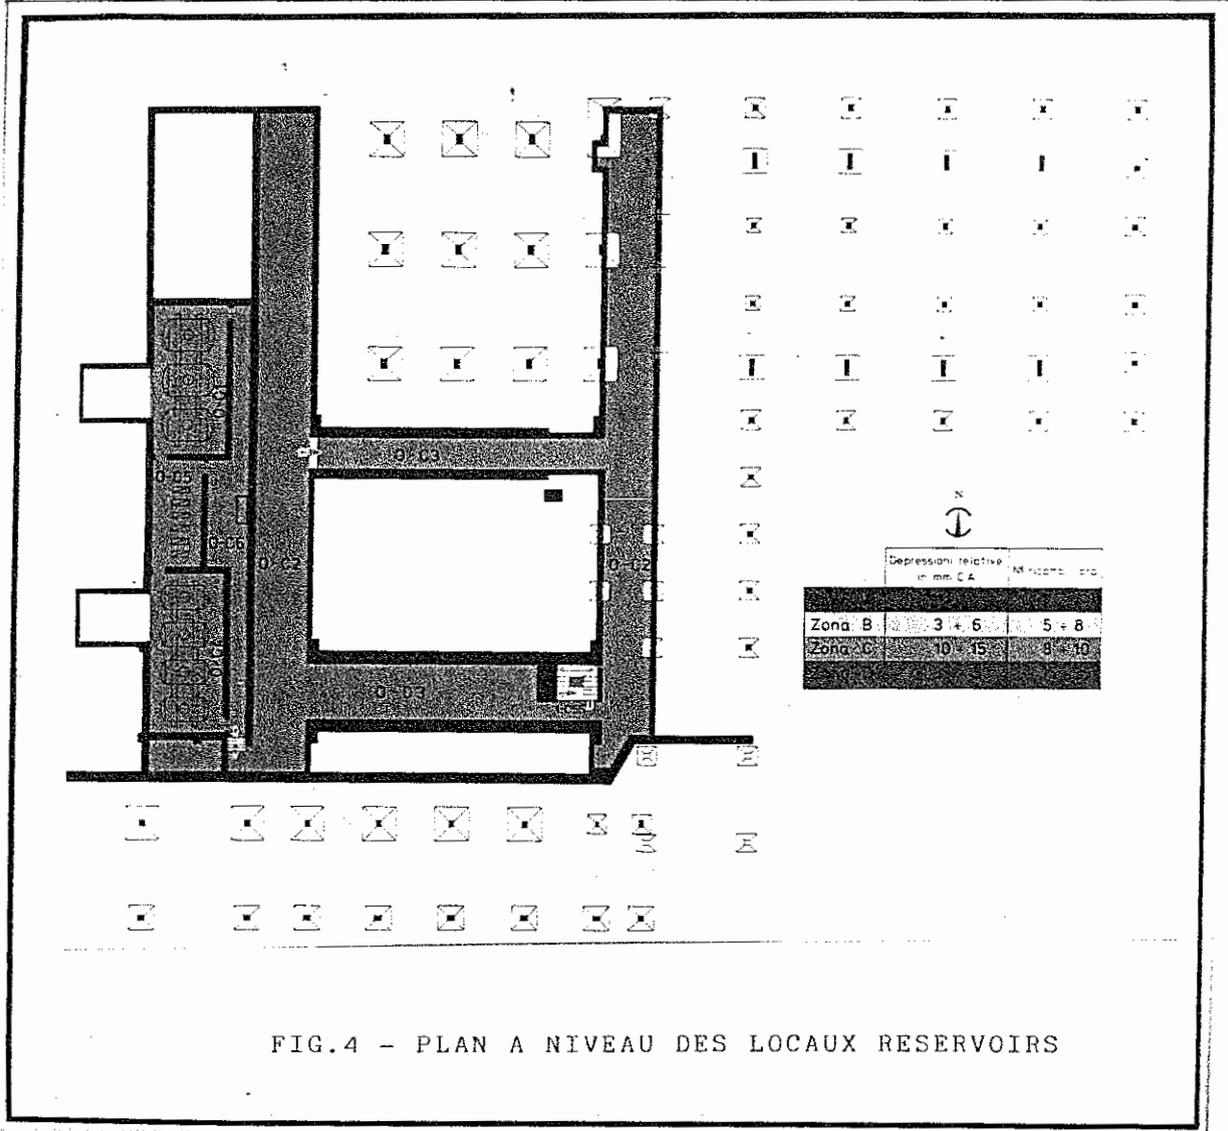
PLAN A NIVEAU DES LOCAUX RESERVOIRS
